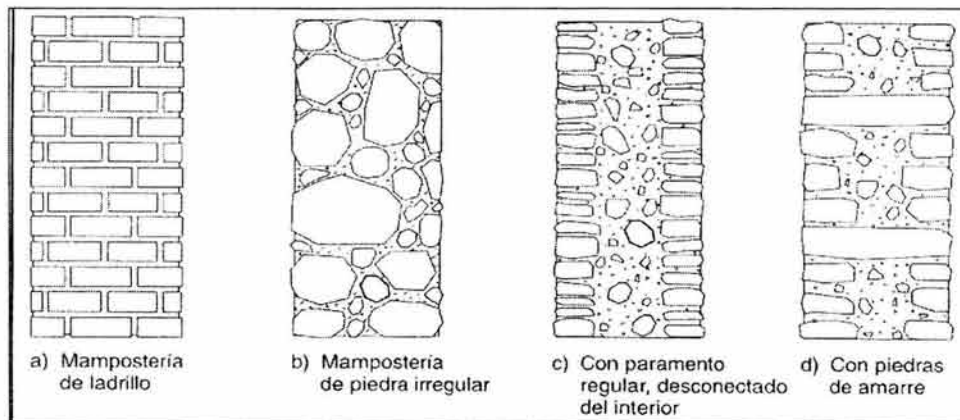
Tipos de mampostería (Meli, 1998)
